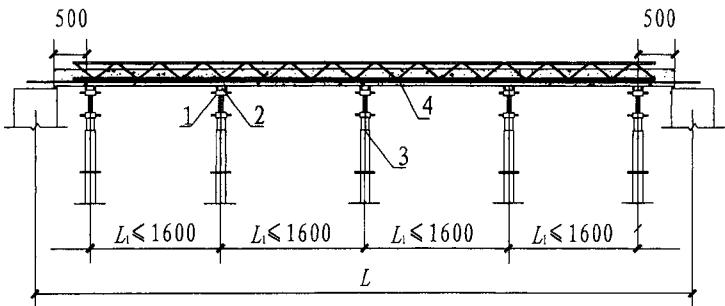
钢筋桁架混凝土叠合板预制底板支撑示意
